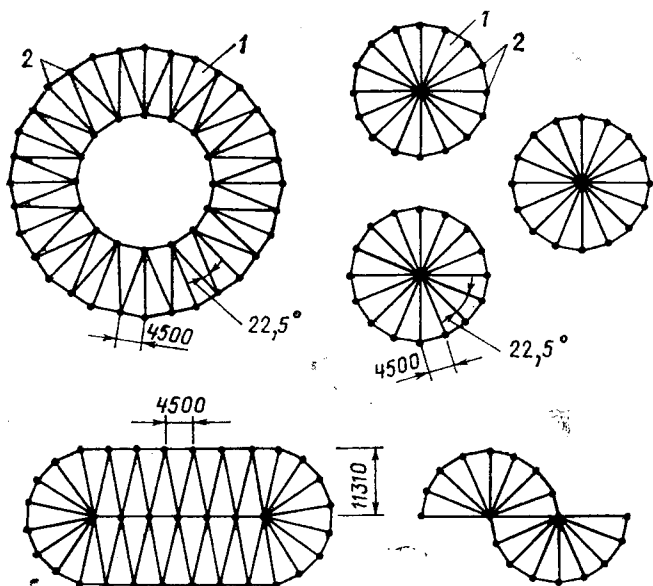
Возможные габаритные схемы сборного железобетонного каркаса
